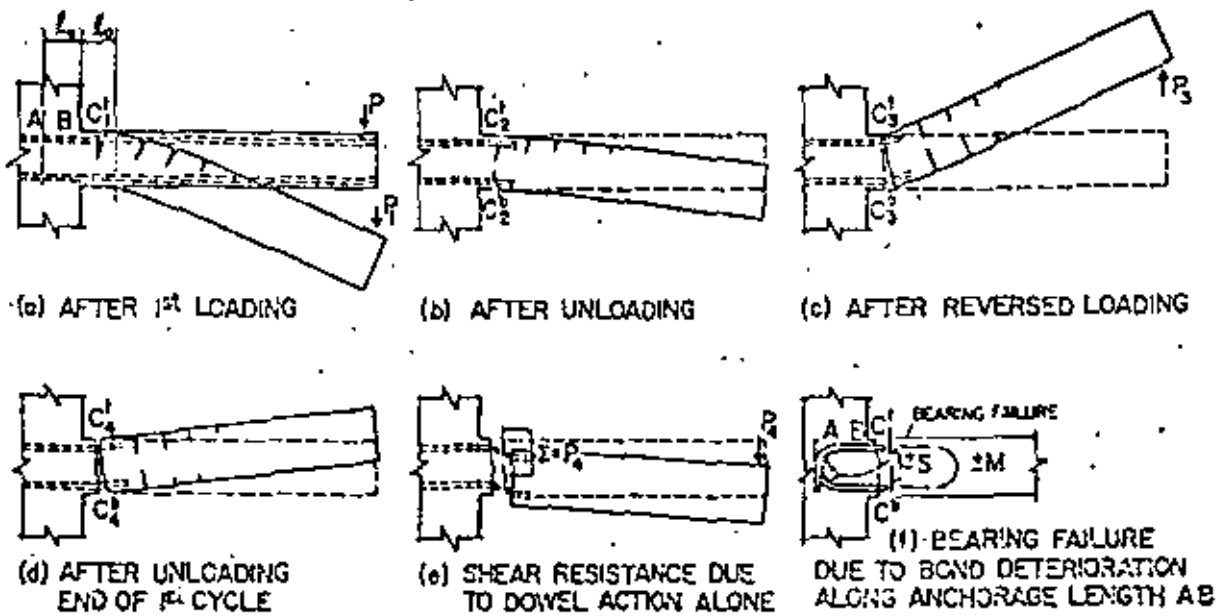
EFECTO DE CARGAS ALTERNANTES EN EL CONCRETO ARMADO
